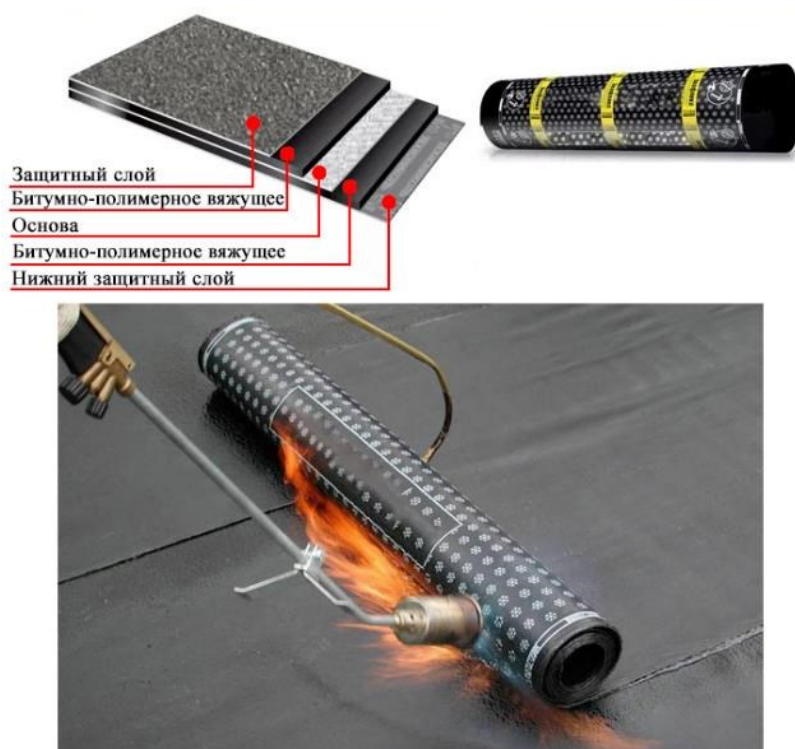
Наплавляемая гидроизоляция бетонных покрытий
